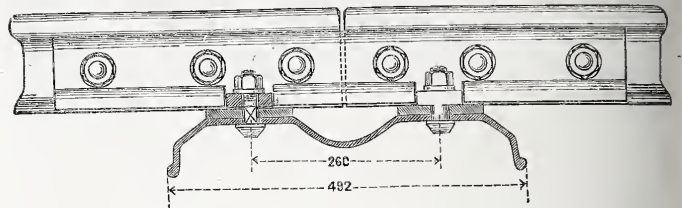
Stoßverbindung auf eisernen Doppelschwellen.
